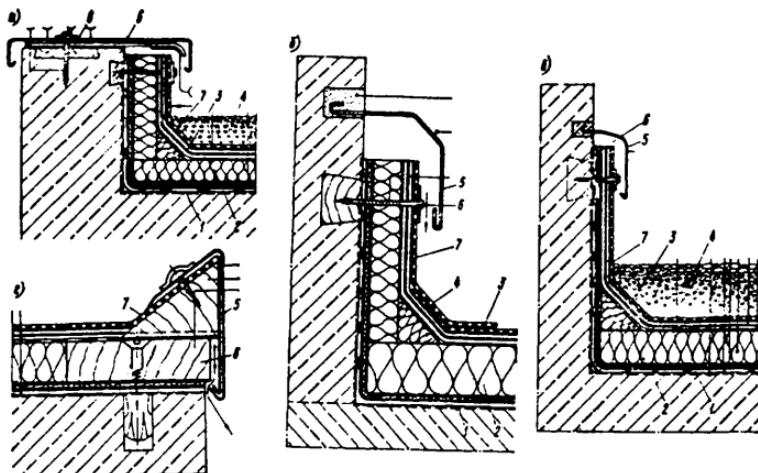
Конструкции примыкания утепленных и защищенных кровель:
